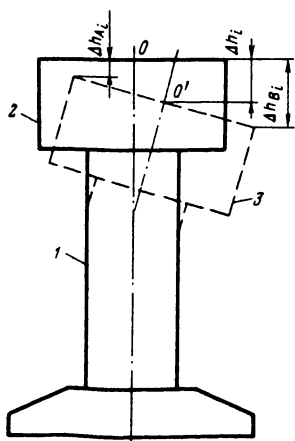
Схема измерения перемещения верха фундамента по высоте:
